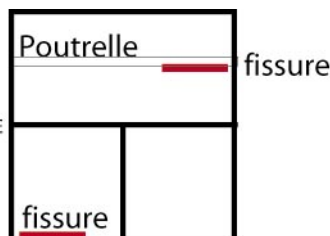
fissures entre mur extérieur et dalle de plafond (restaurant scolaire Grand-Champ)
